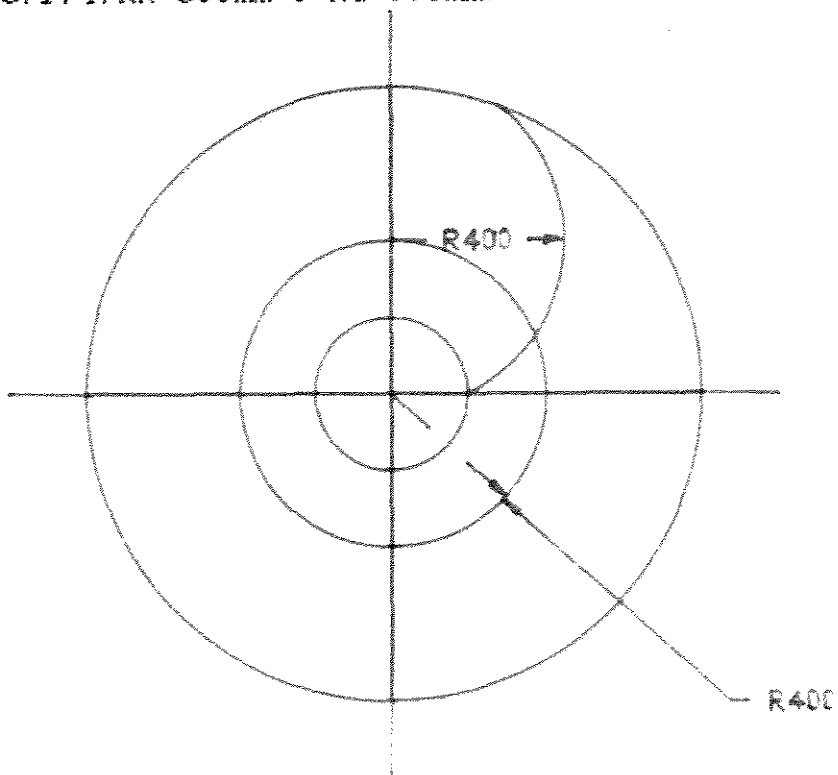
RR=400mm e RC=400mm.
